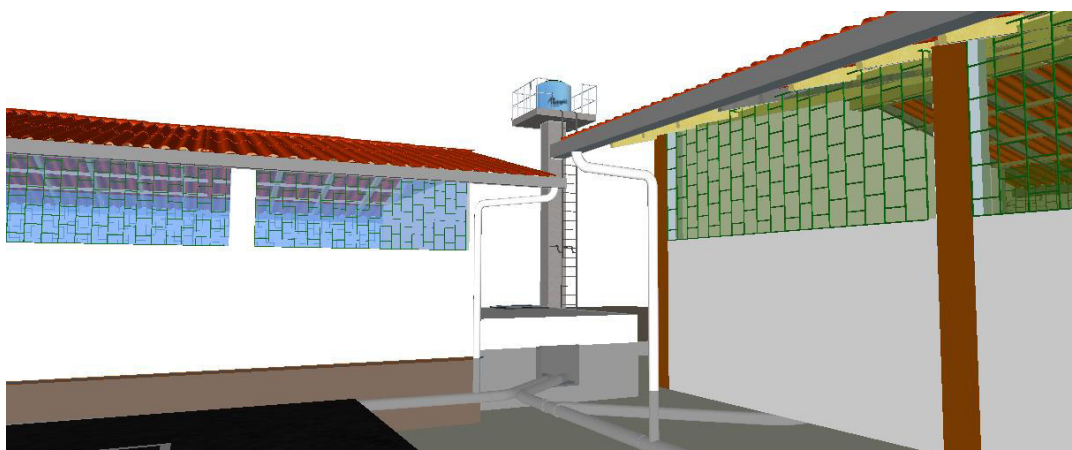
Detalle de contribución de tubería de desagüe a cisterna y tanque elevado
